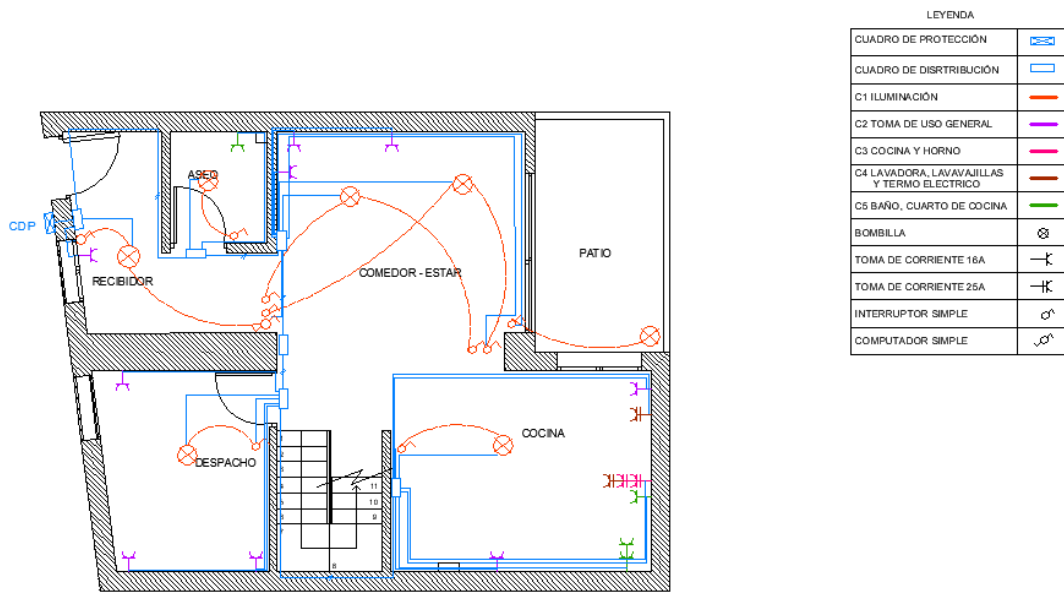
Croquis de sistema eléctrico planta baja. Fuente propia
